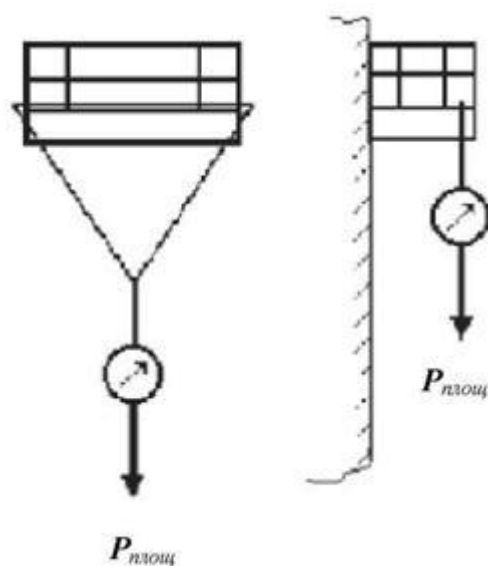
Схема приложения испытательной нагрузки для площадки лестницы
